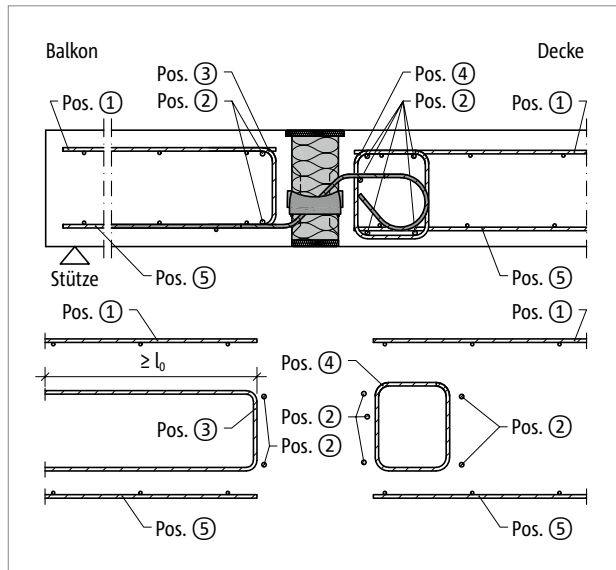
Schöck Isokorb® T Typ QL: Bauseitige Bewehrung
